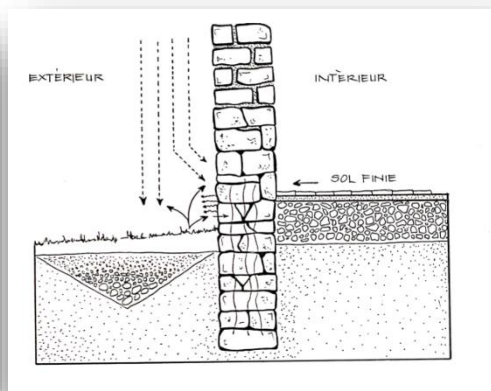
Fondation-soubassement en pierres maçonnées, drain enterré, tomettes sur dalle chaux et hérisson. Source : Auteure.2022 adapté du guide des bonnes pratiques de la construction en terre crue.2018.
